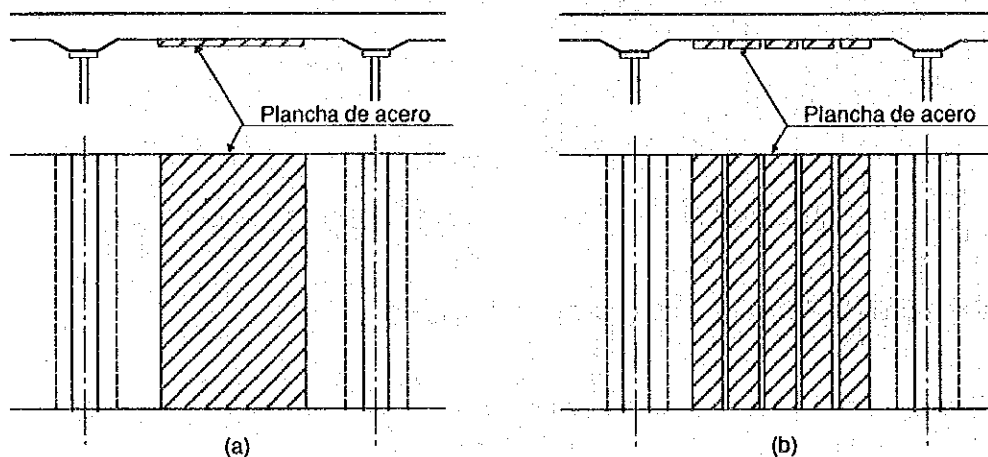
Refuerzo con placas de acero pegadas a la losa
